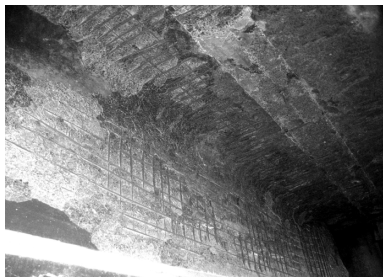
主梁混凝土保护层剥落钢筋锈蚀
